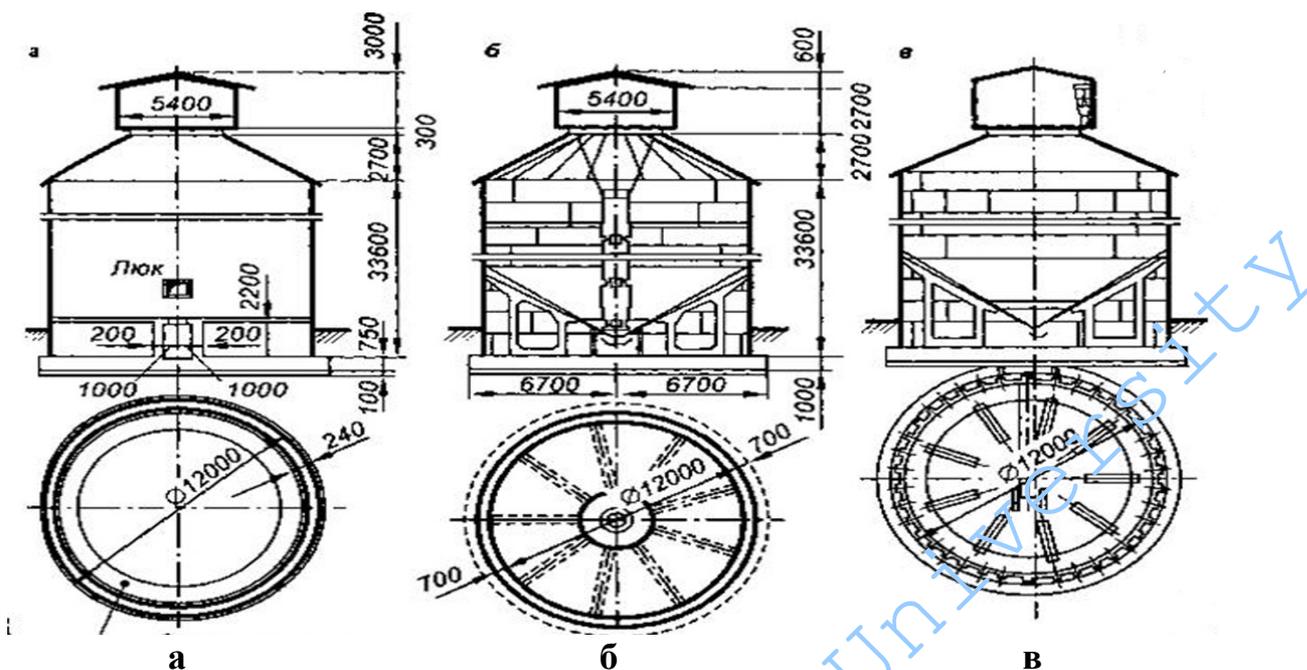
Варианты конструкций железобетонных силосов диаметром 12 м.
